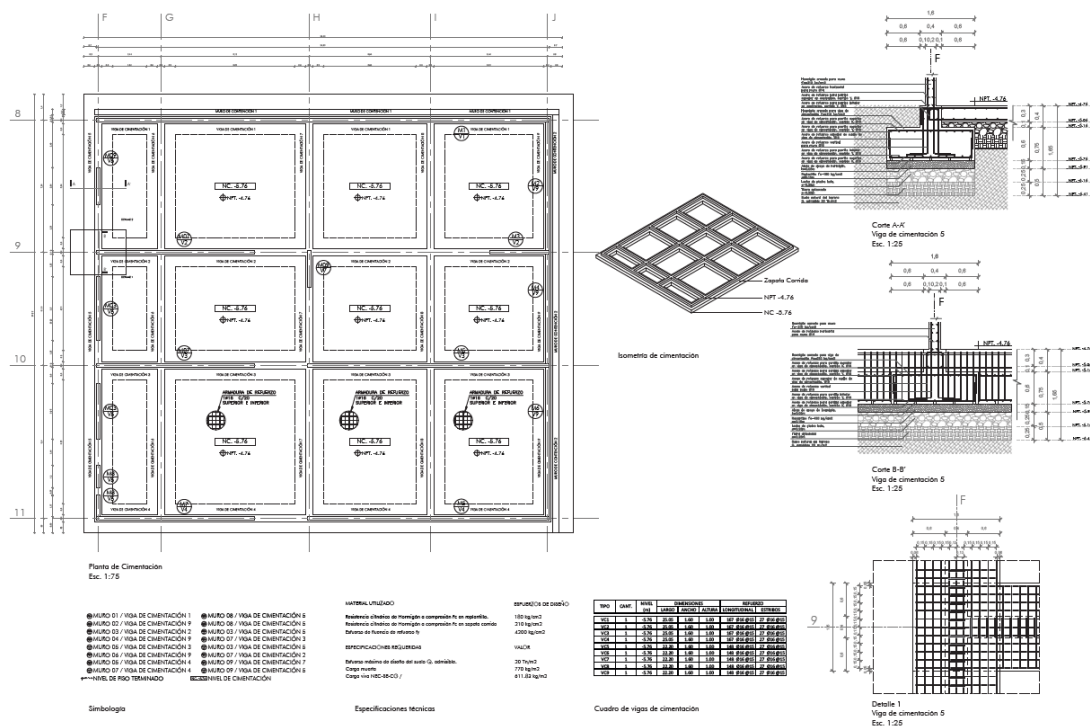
Sistema estructural de cimentación, elaborado por Mendoza, 2020
